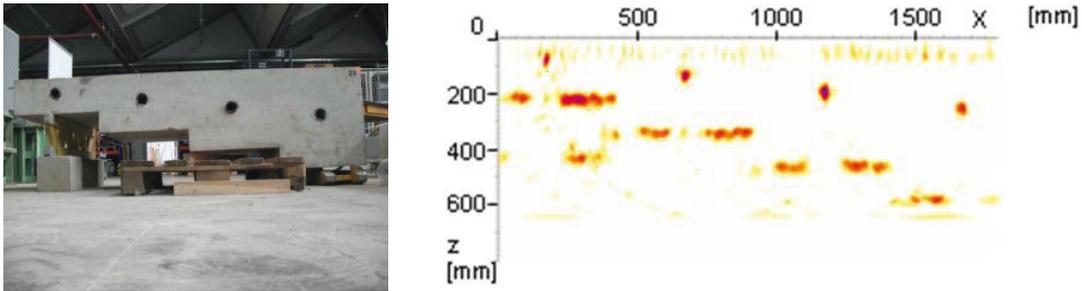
Links: Stufen-Testkörper aus Beton mit Hüllrohren. Rechts: Mit SAFT ausgewertetes Ultraschall-Echo-Linienprofil. Stufen und Hüllrohre erkennbar (Quelle: BAM).
